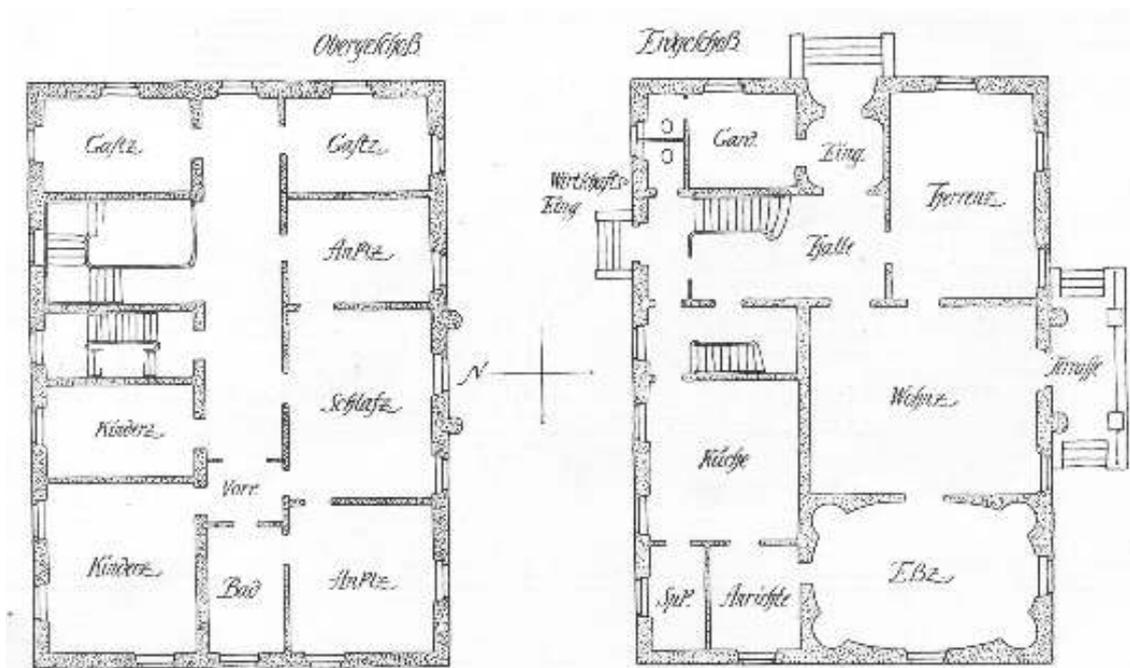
Paul Schultze-Naumburg: Größeres Wohnhaus mit 19 Zimmern, Grundrisse Ober- und Erdgeschoss
